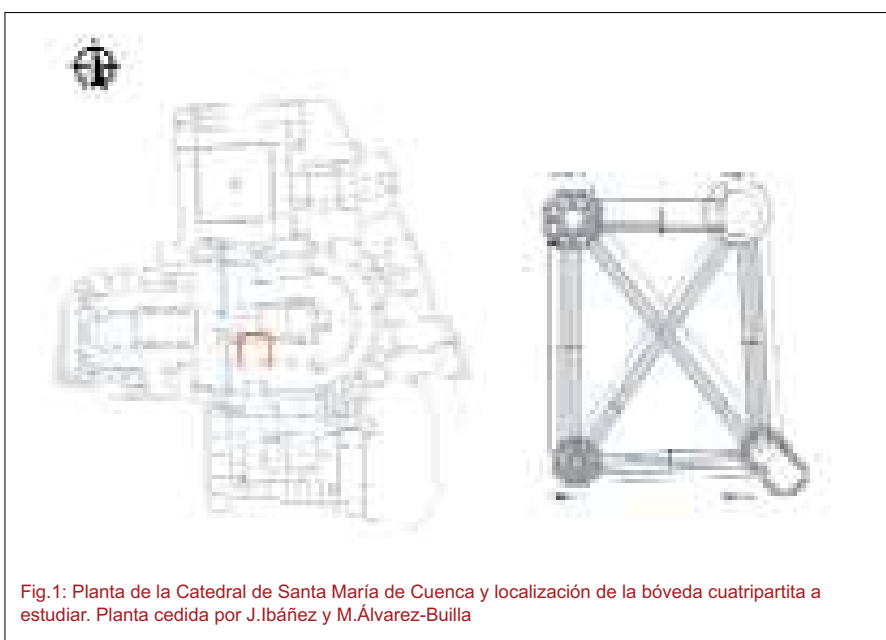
Planta de la Catedral de Santa María de Cuenca y localización de la bóveda cuatripartita a estudiar. Planta cedida por J.Ibáñez y M.Álvarez-Builla
